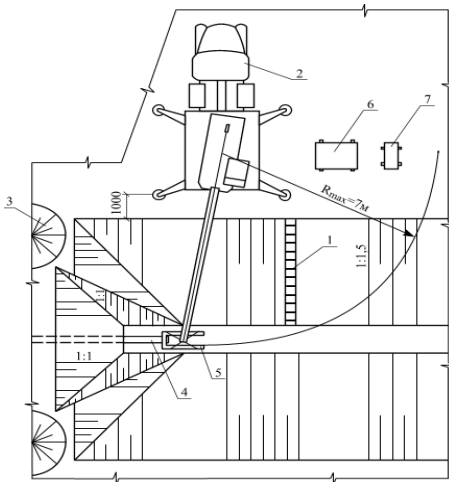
Монтаж залізобетонних конструкцій при ремонті гирлової споруди.
